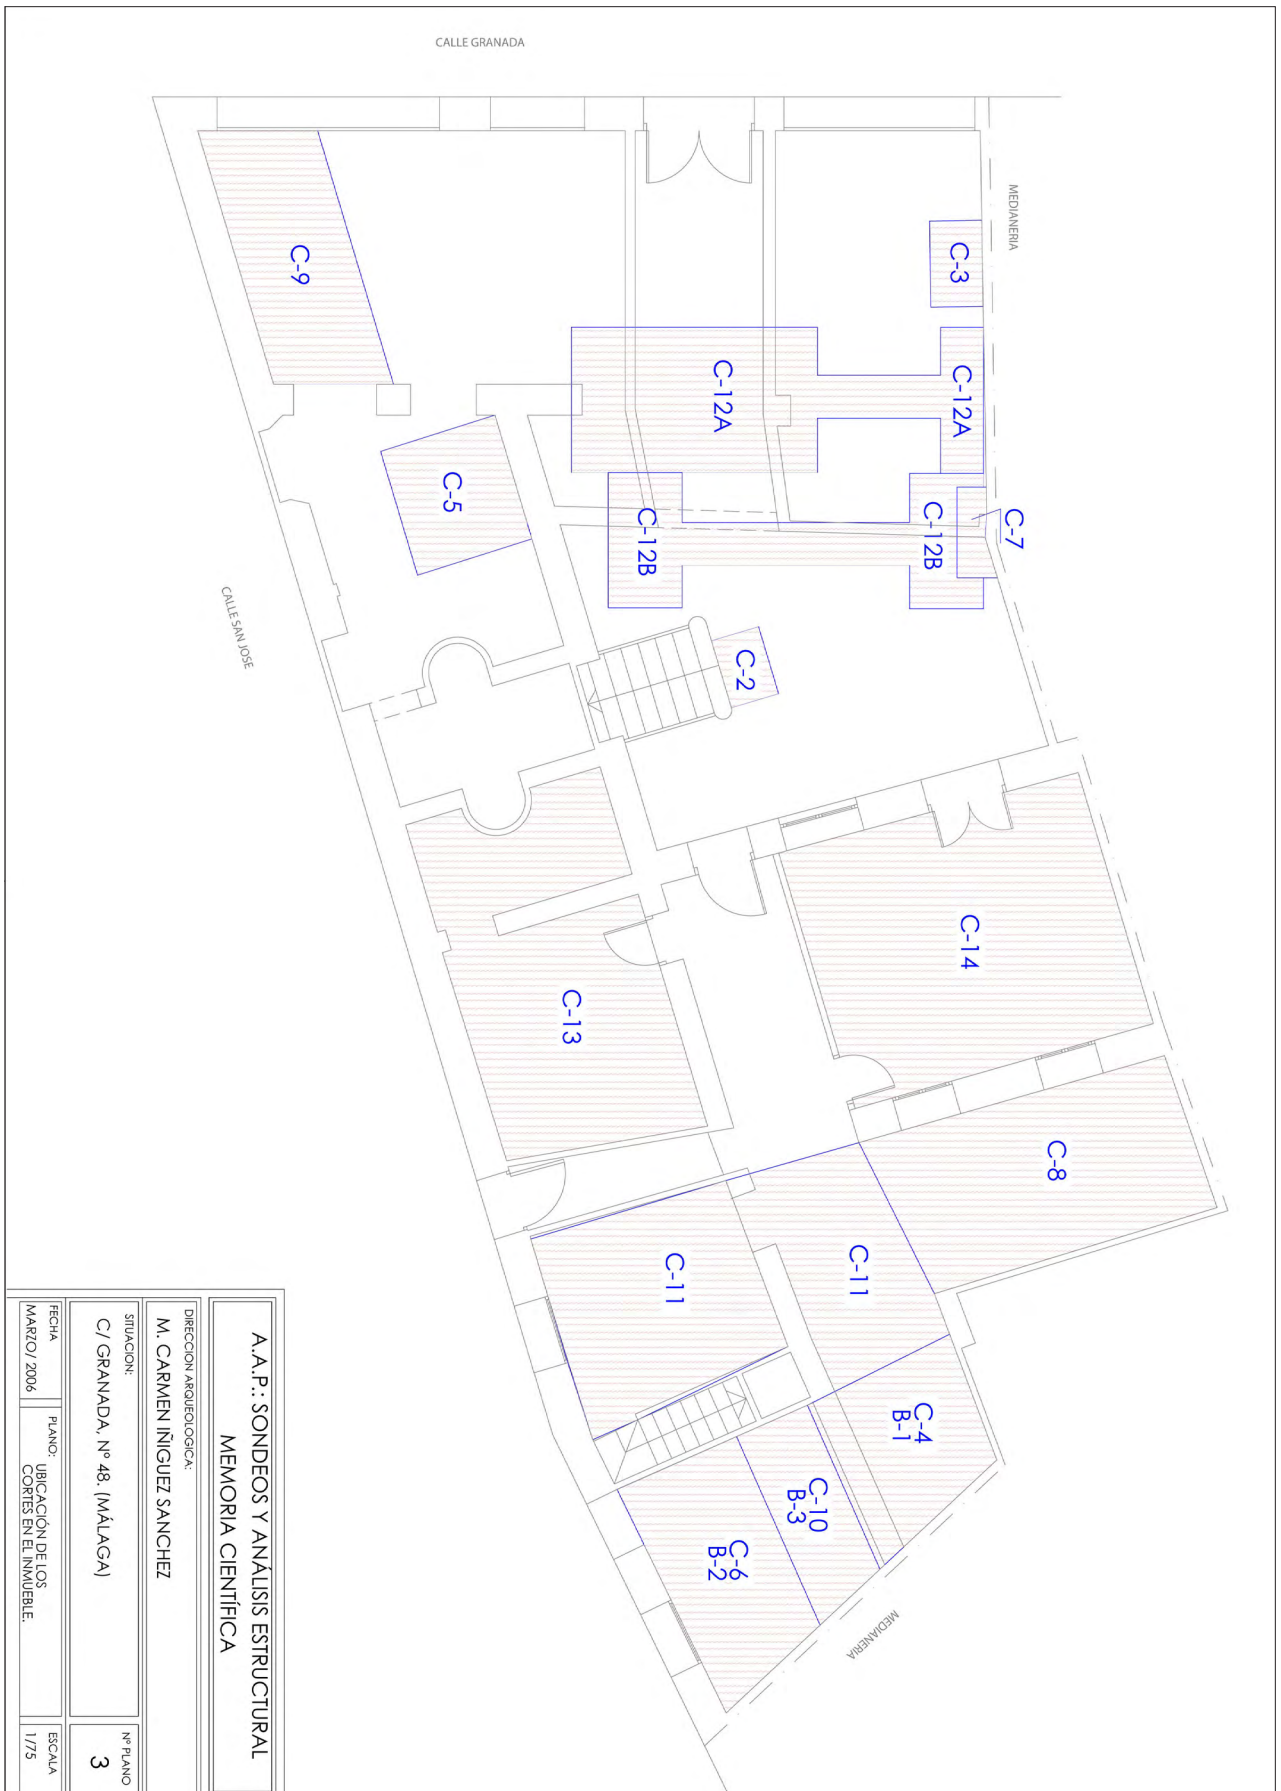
Ubicación de los cortes en la planta baja del inmueble.
